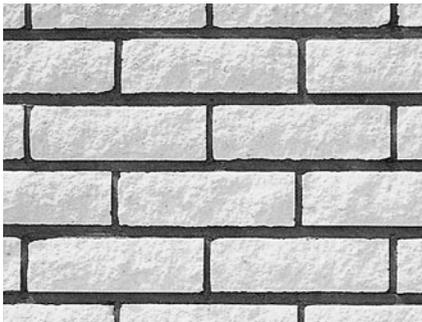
/4: Bei KS-Verblendmauerwerk mit ca. 1 cm dicken Stoß- und Lagerfugen handelt es sich um eine Bauweise mit Fuge.
